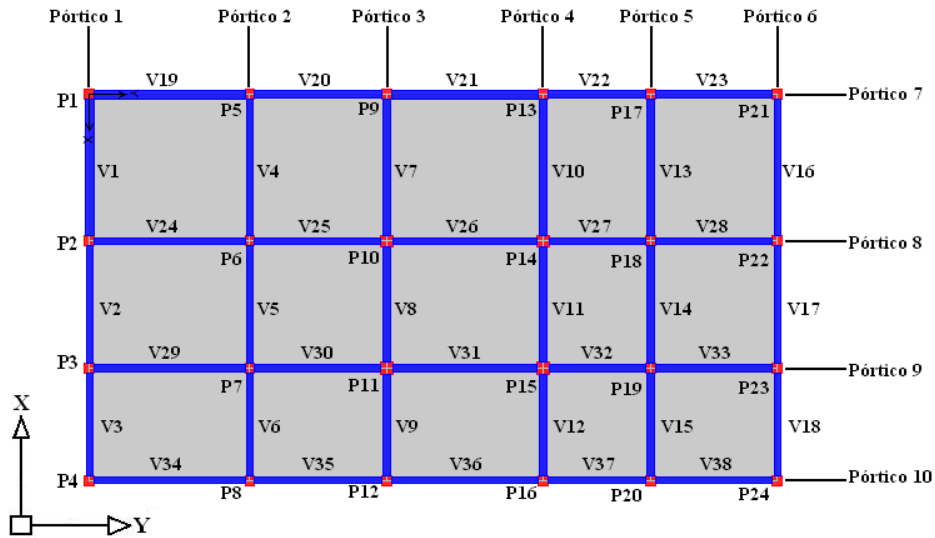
Vista em planta da estrutura sem irregularidades em sua forma com os elementos numerados.
